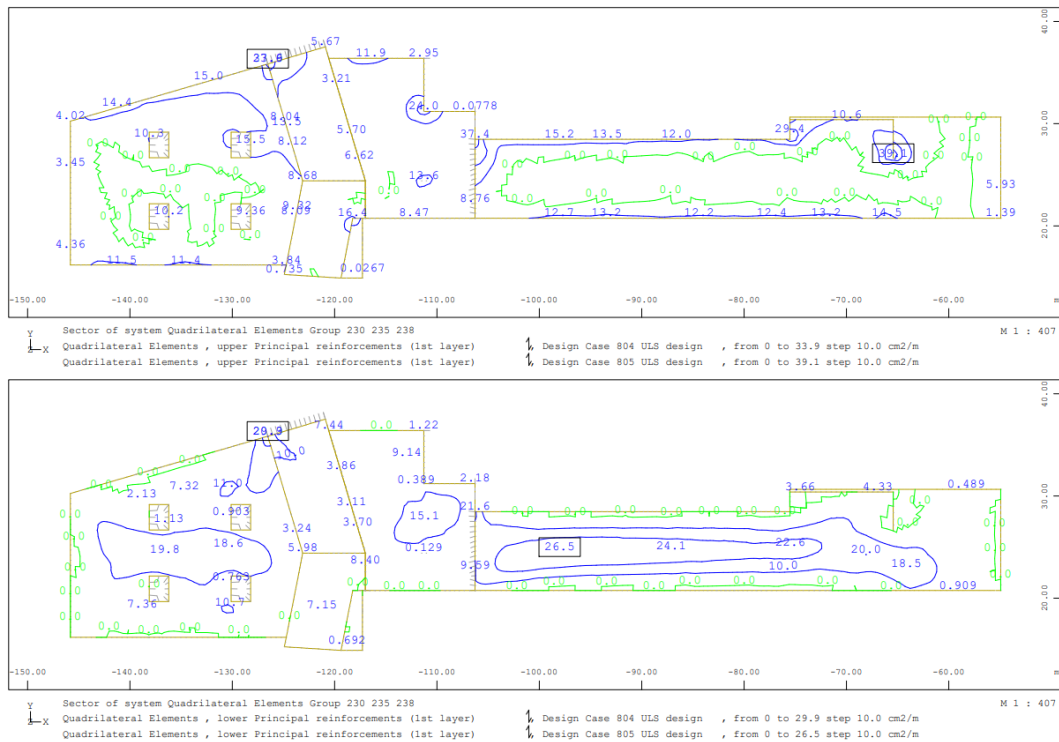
Armadura principal na face superior (sup.) e inferior (inf.) – laje de cobertura – acesso Norte - ELU
